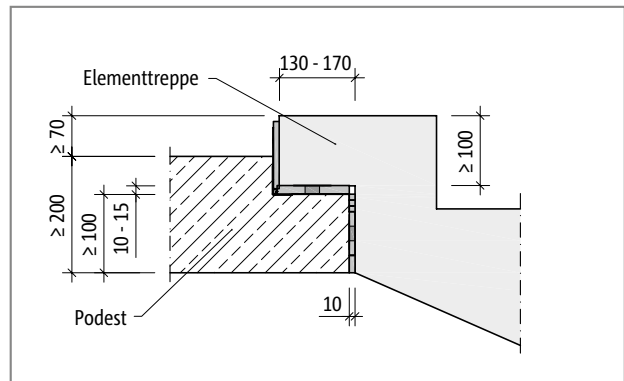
Schöck Tronsole® Typ BZ: Ausführungsvariante Auflagerung eines Elementtreppenlaufs am Podestrand mit Konsolausbildung
